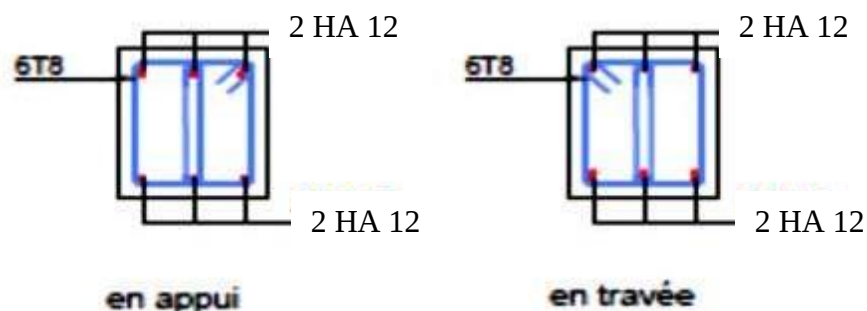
Schéma ferraillage des poutres secondaire.
